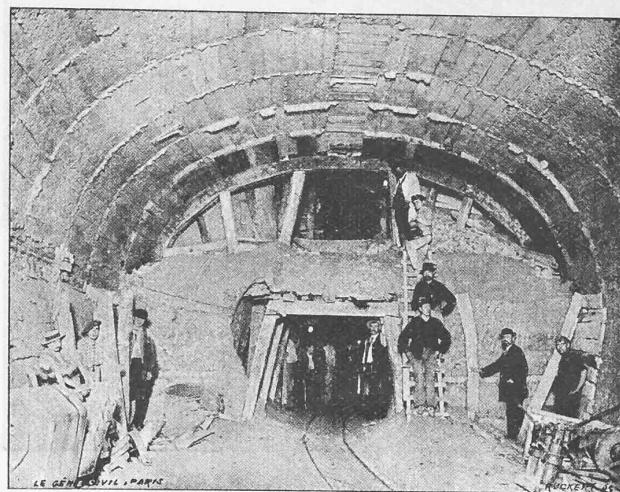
Bau des Tunnels unter der Place de l'Etoile.
